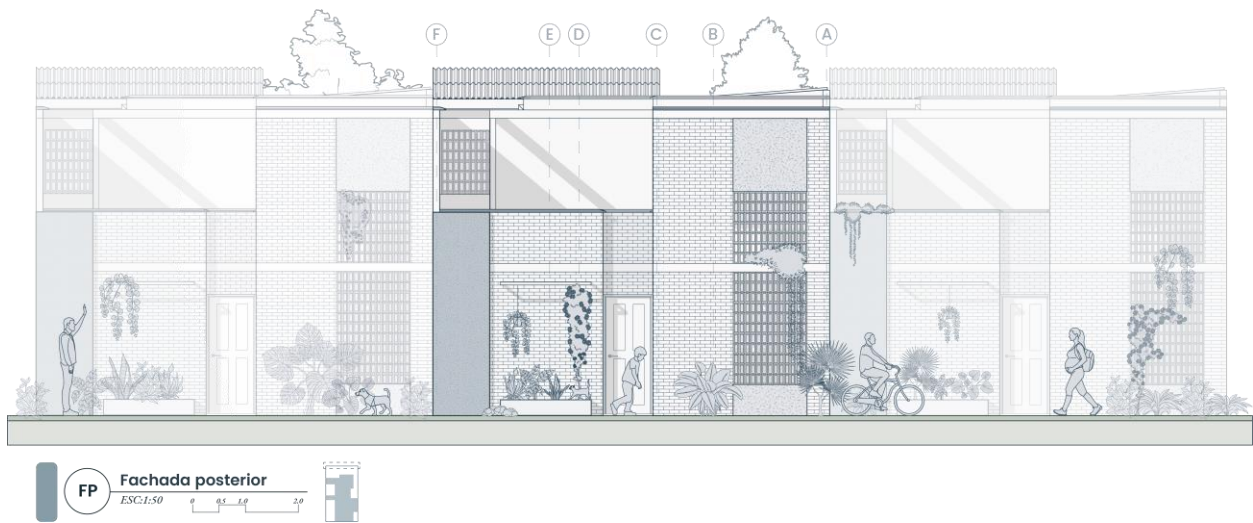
Fachada posterior Casa Patio. Elaboración propia.
